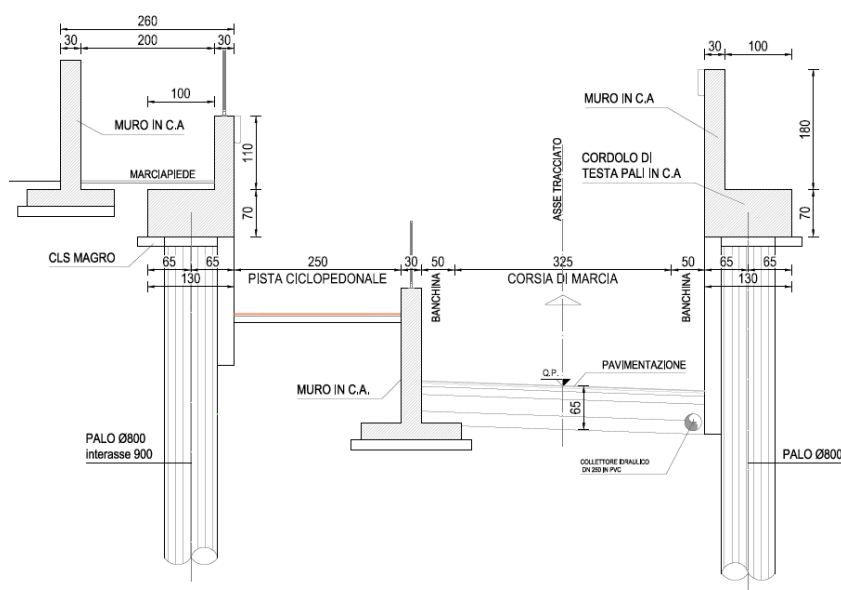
Sezione tipo Stradale STP Via XXIV Maggio
